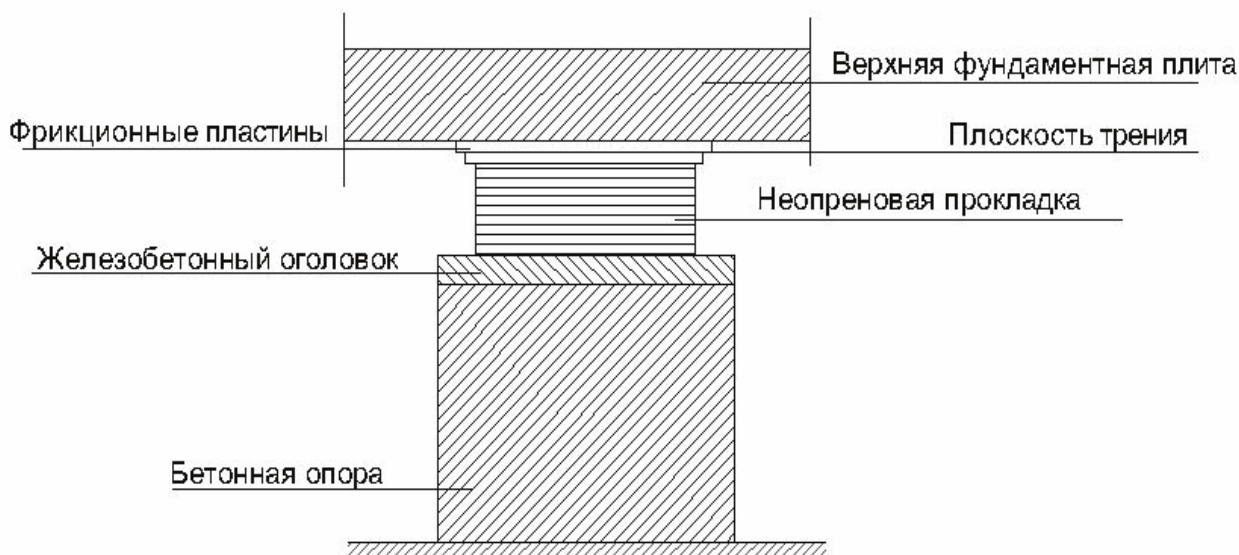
Сейсмоизолирующий фундамент фирмы Spie Batignolle
